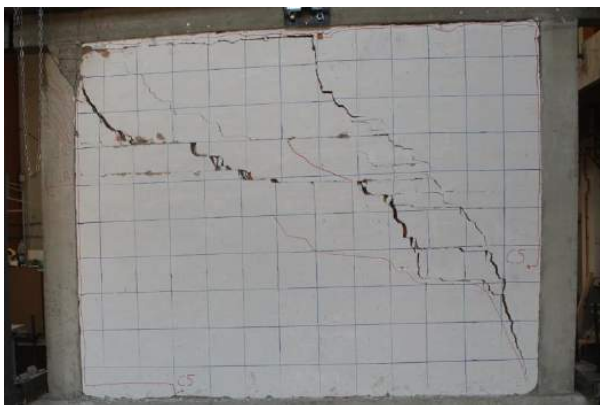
Foto nga ekzaminimi i RBA 1 krahas ramit U 7 ndikimi i murit parapet në shtyllat e ramit – formimi i çernjerave plastike
